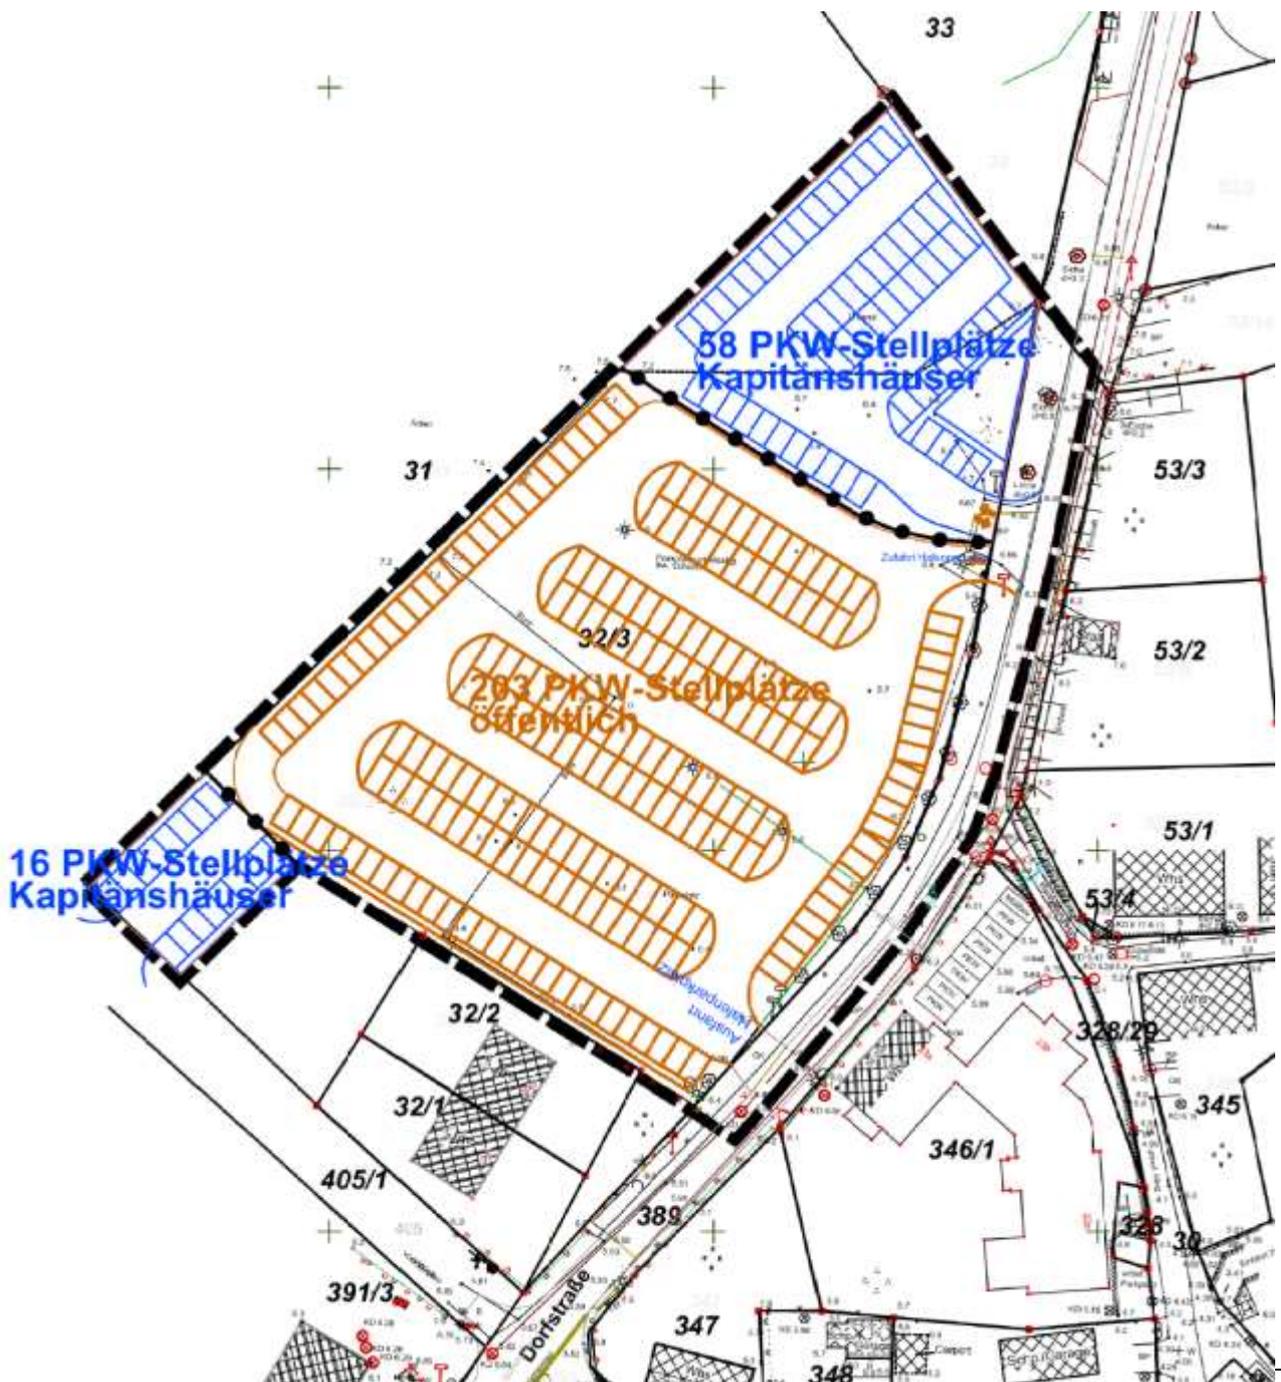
Entwurf; Quelle: WASTRA-Plan, Stand 01/2016
